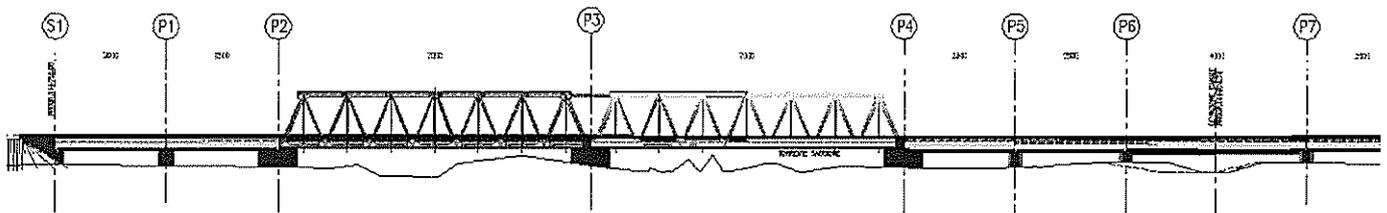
Viadotto sul torrente Saccione: stralcio del prospetto
